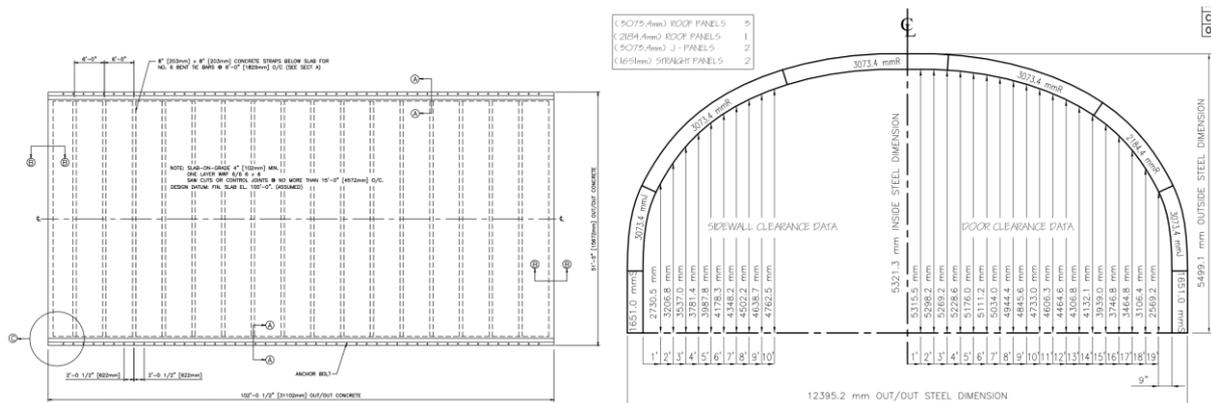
Pianta e sezione trasversale del modulo prefabbricato di ricovero ovini (esempi)
